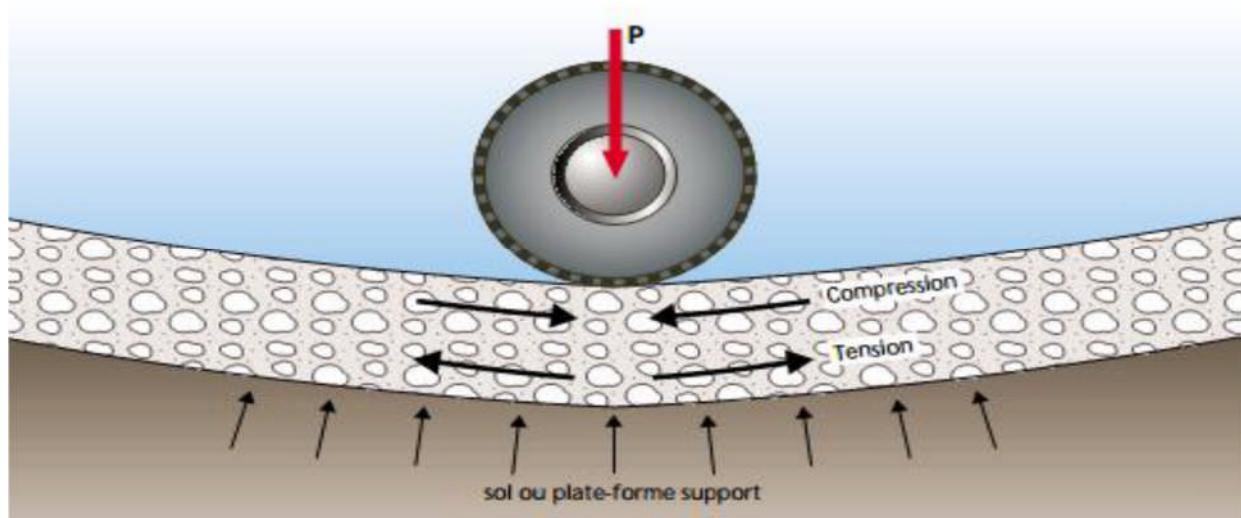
Schéma de fonctionnement d'une chaussée constituée d'une couche traitée au ciment reposant sur le sol naturel
